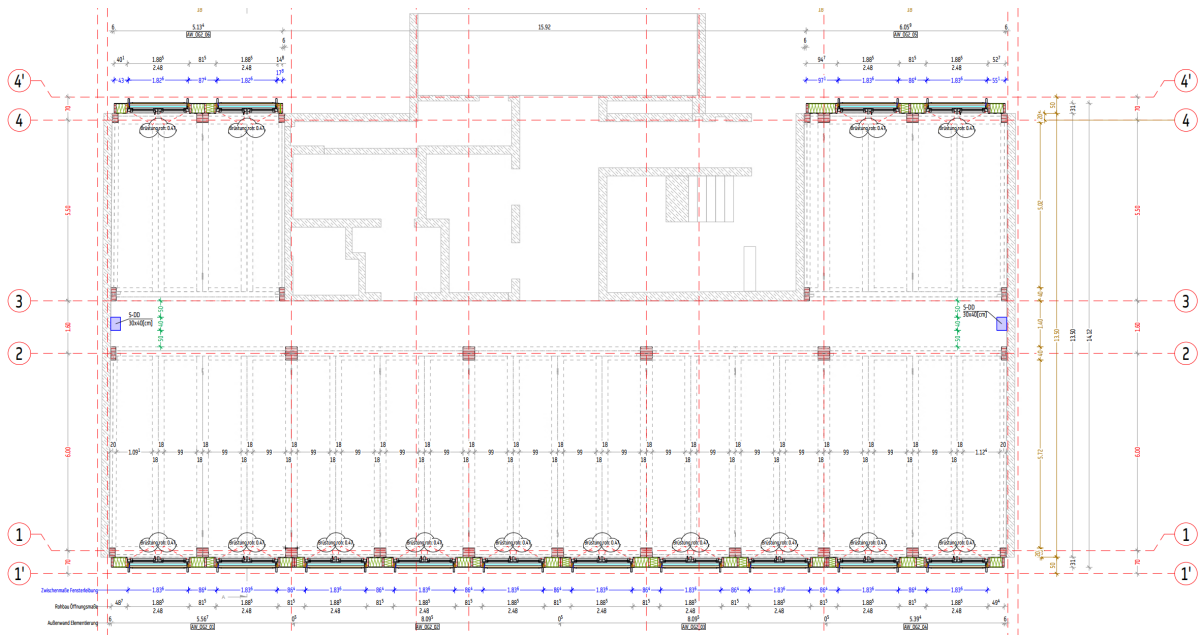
Grundriss Regelgeschoss Vorderhaus (Sieveke)
